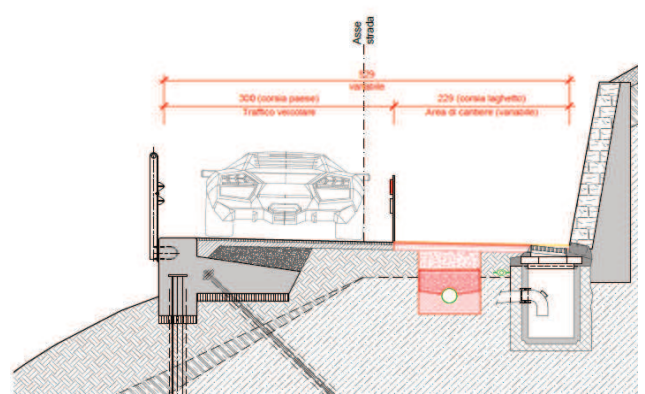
Sezioni stradali fasi di lavoro e traffico
